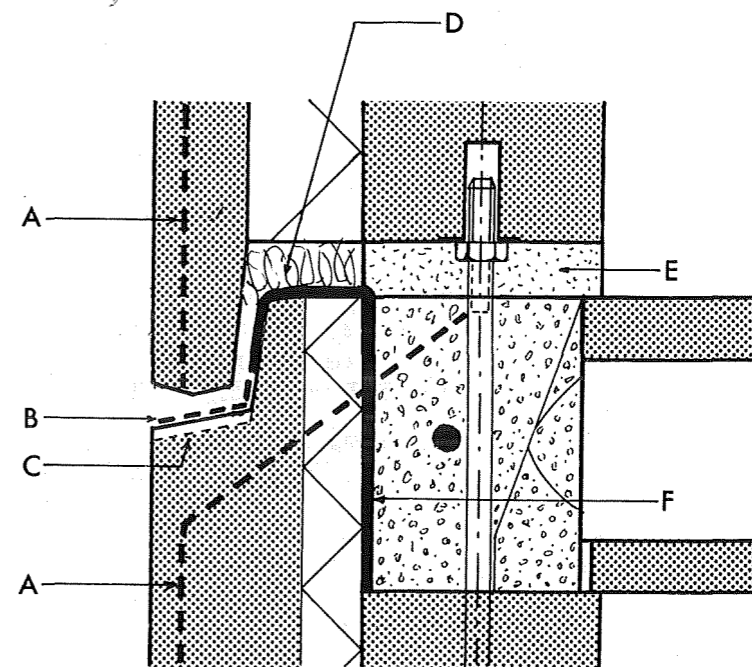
2-trinstætning i lodret fuge i betonfacadeelementer.
